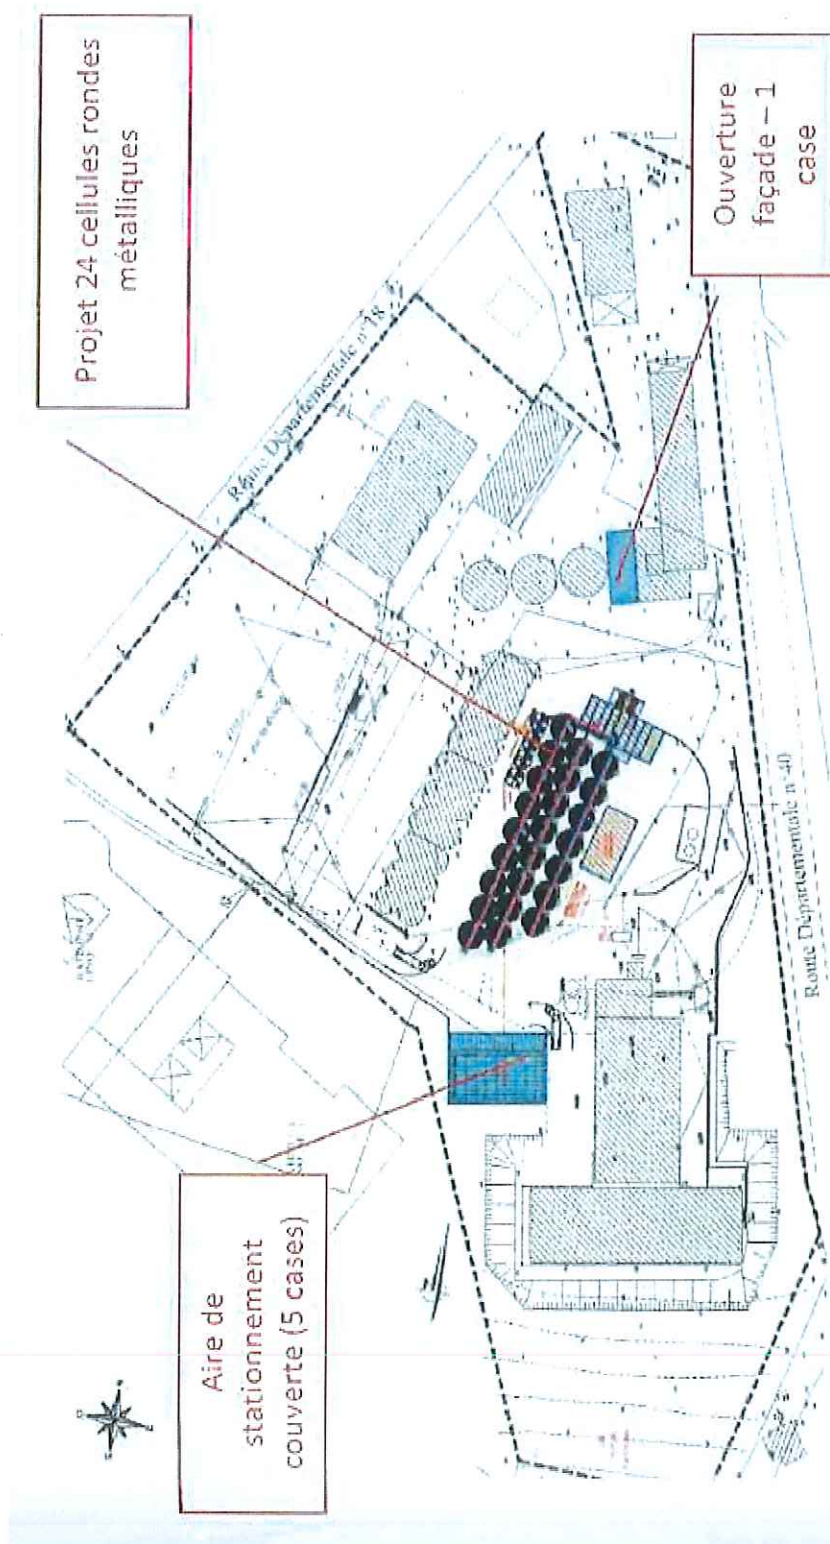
Plan de repérage des projets de modification (sans échelle)
